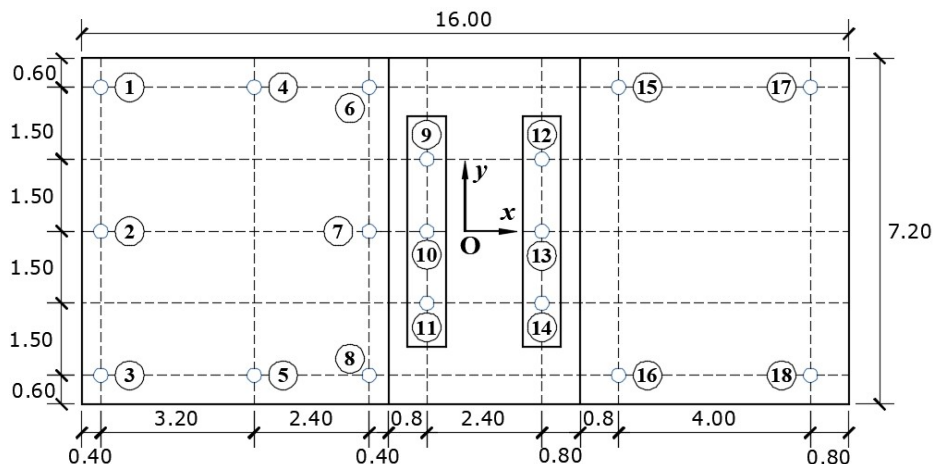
Geometría en planta con los puntos de carga en el sistema de fundación
